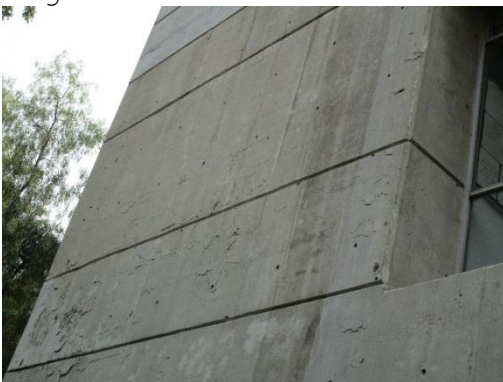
Fisuras en muro. Foto 15.
